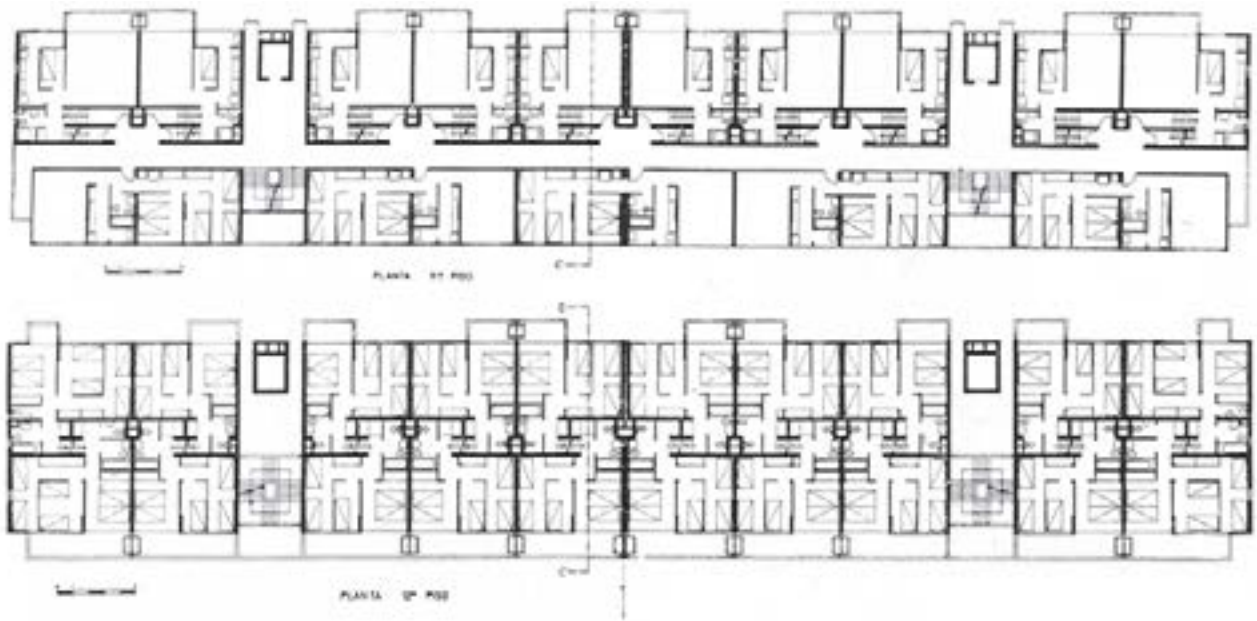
Planta de arquitectura y distribución espacial del proyecto.
